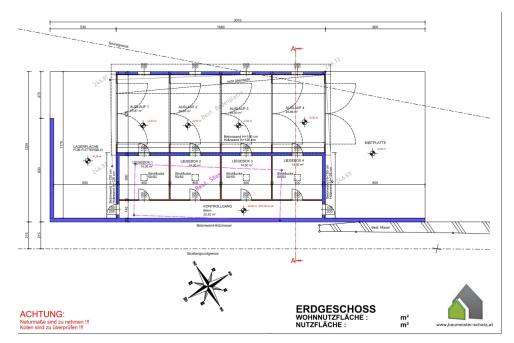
Grundriss Stallgebäude EG, Planungsbüro Schatz KG
